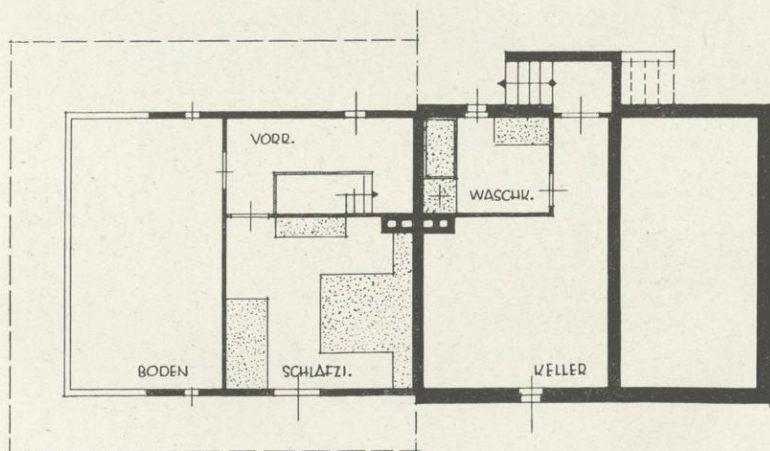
Raumausteilung (Grundriß) des Siedlungshauses St. Peter-Linz Type A
